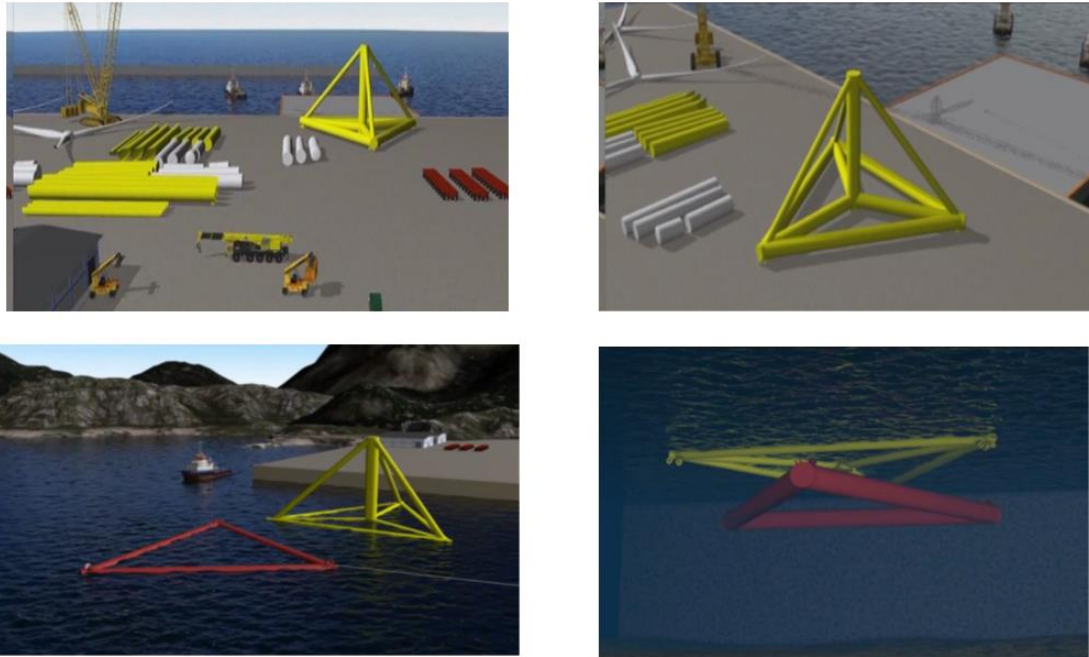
Fasi di assemblaggio di una piattaforma galleggiante
